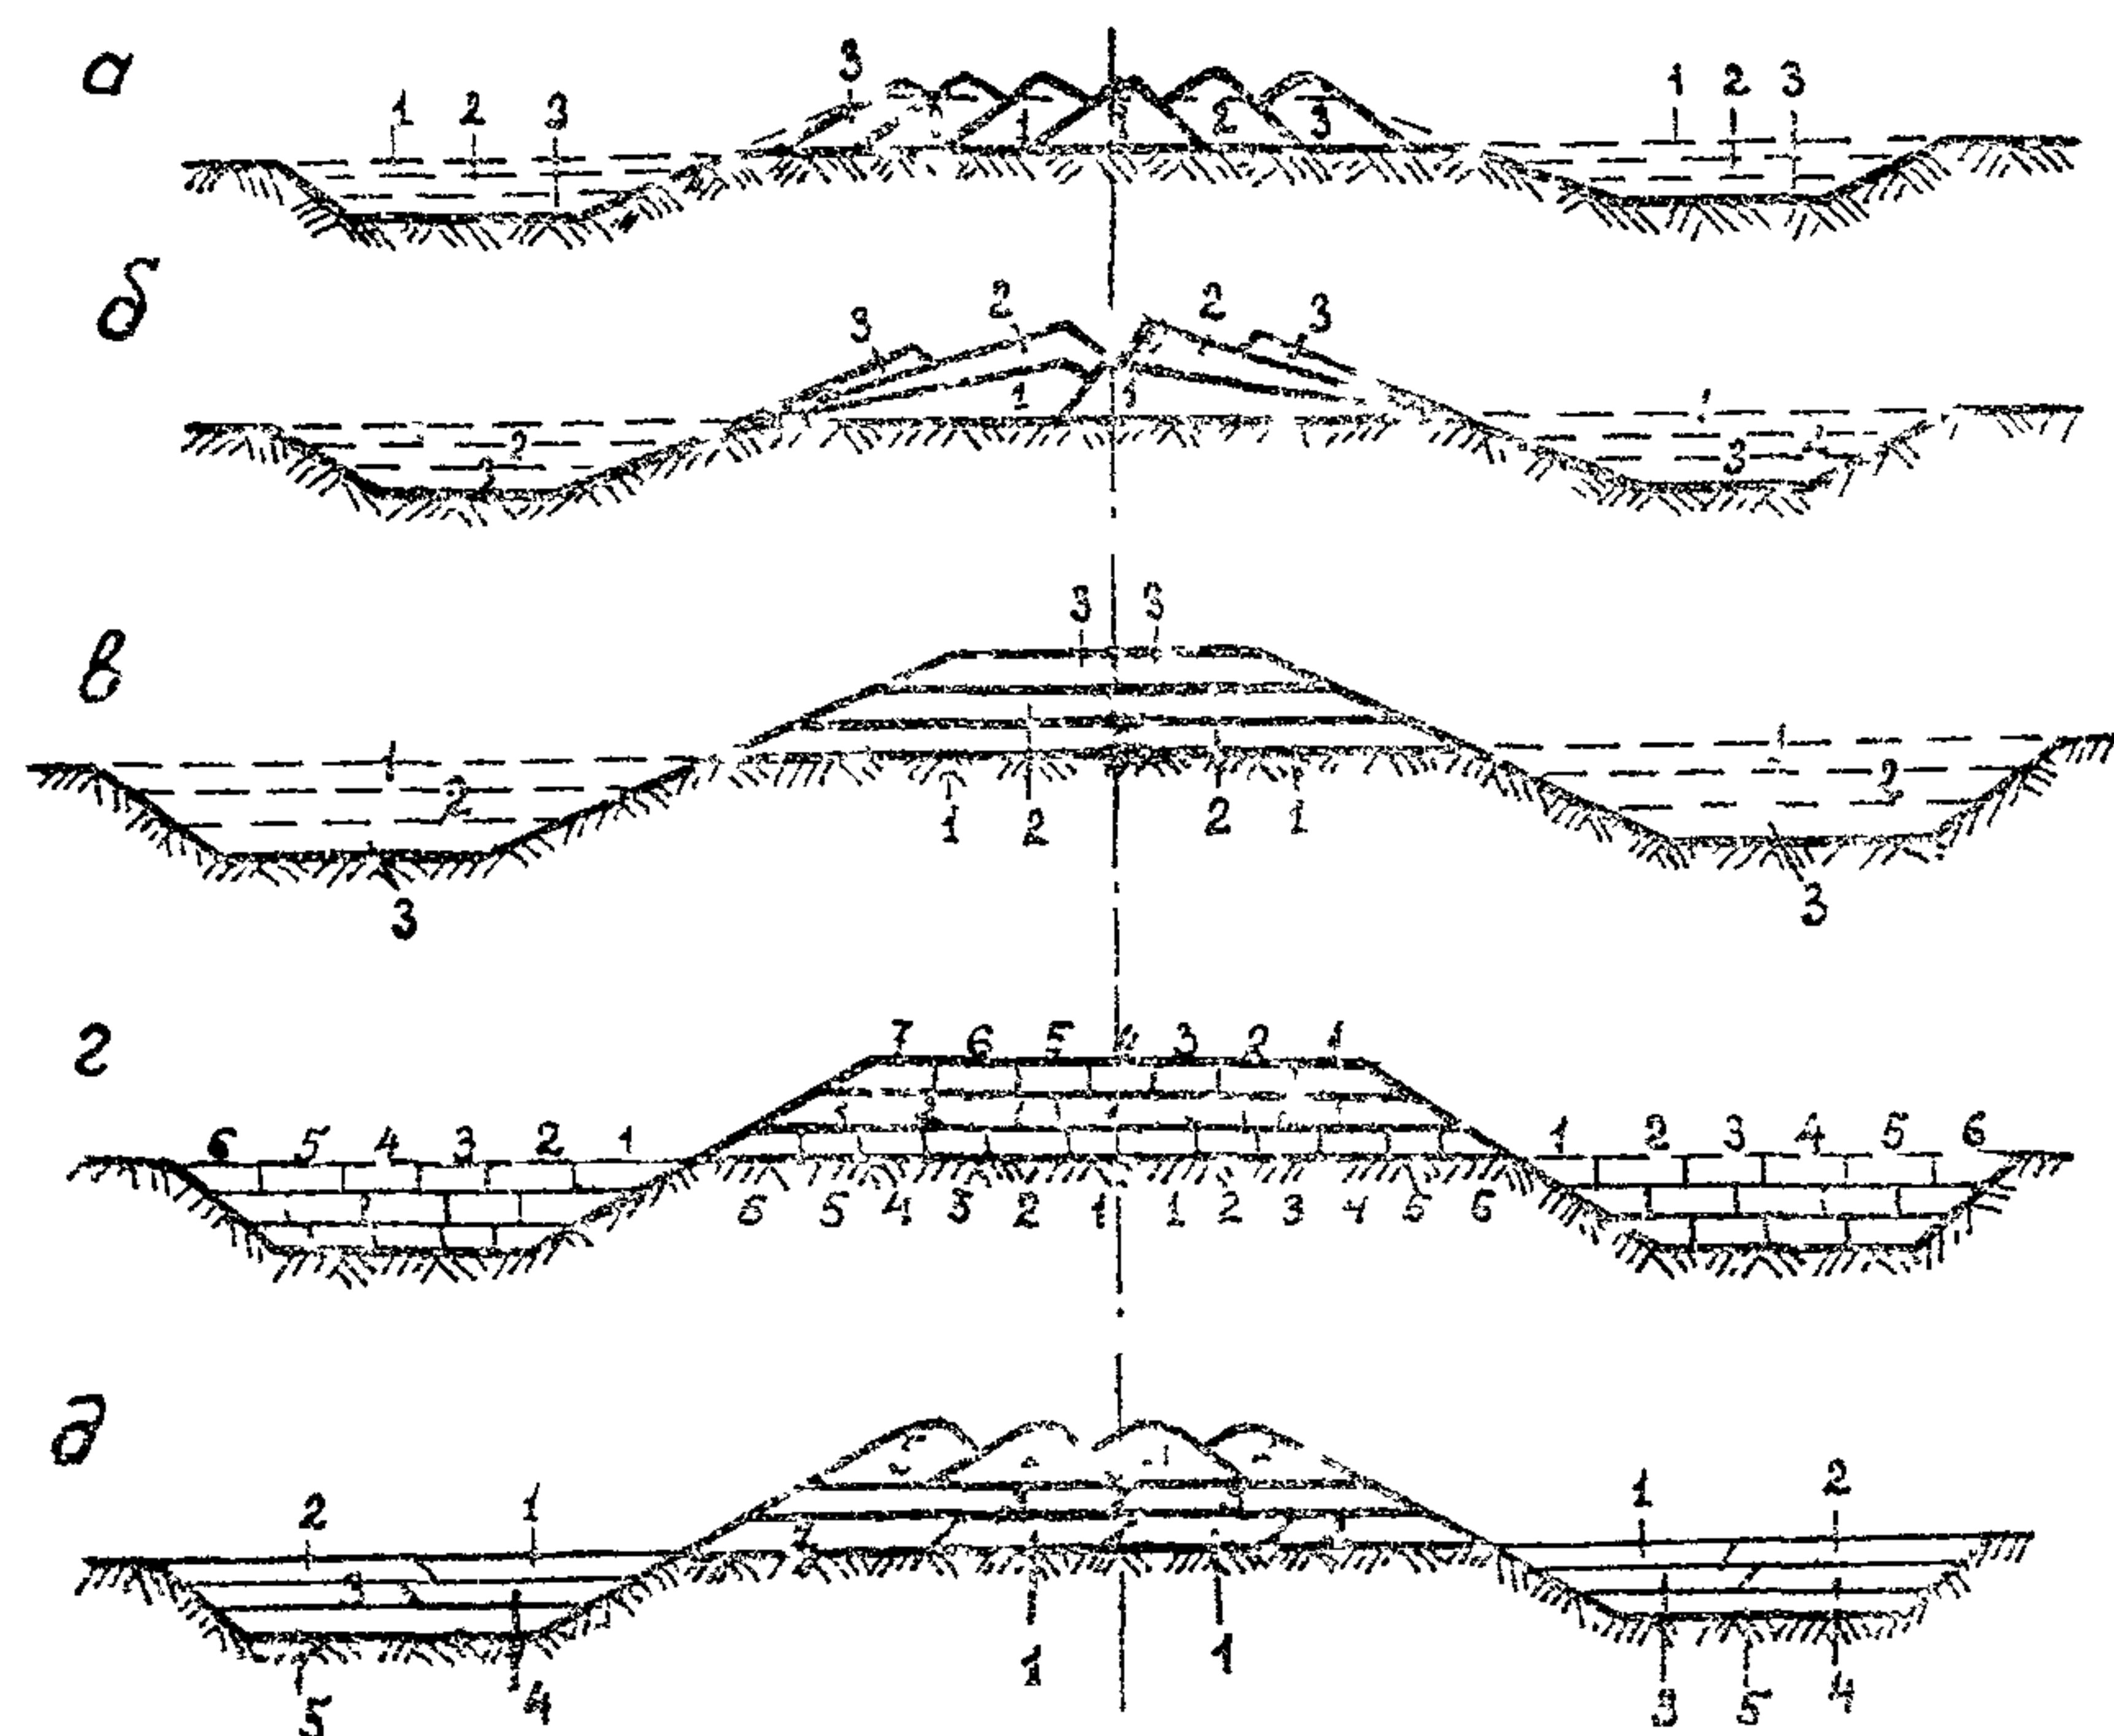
Схемы разработки двусторонних резервов и укладки грунта в насыпь:
